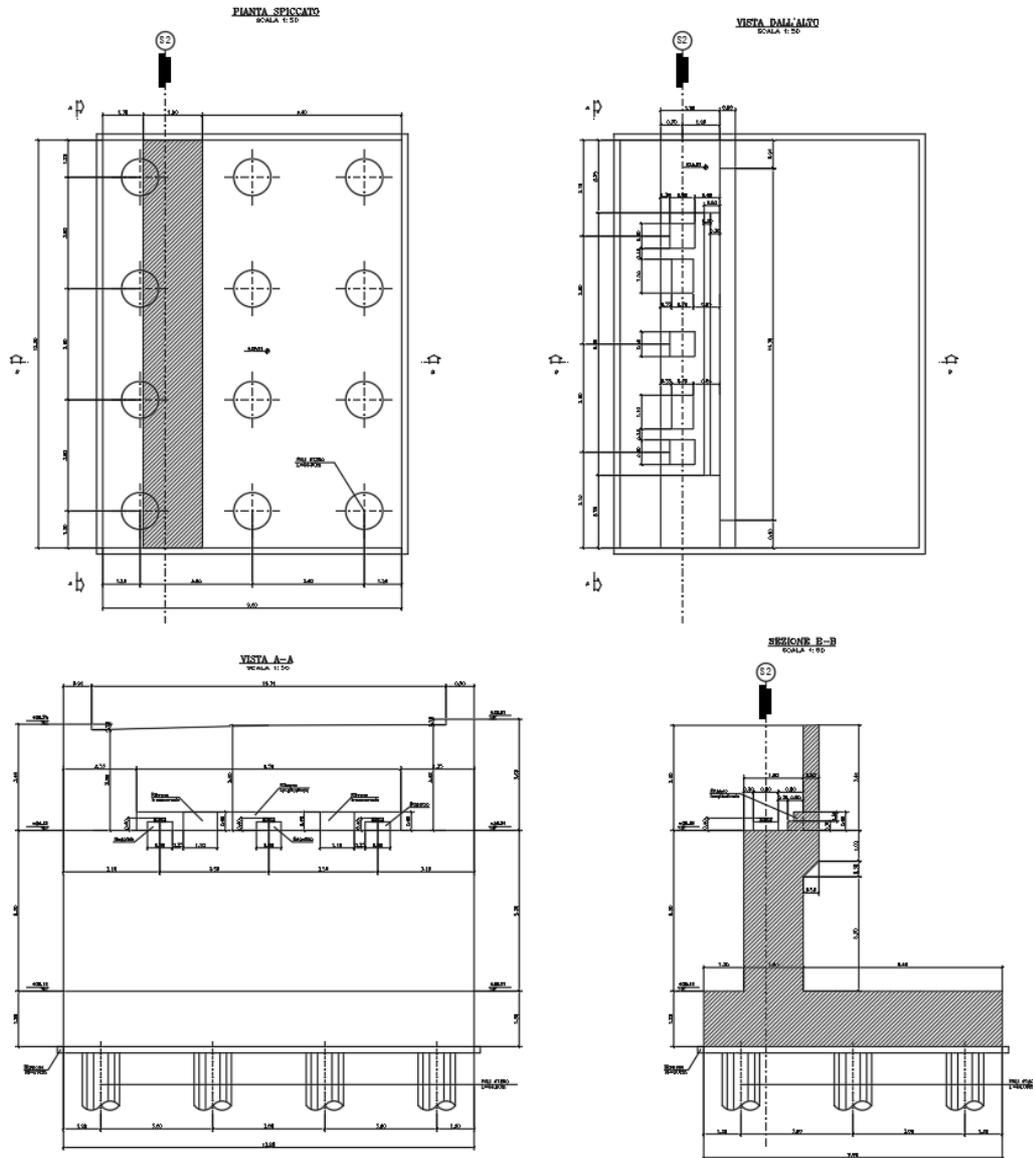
Sezione trasversale e pianta - Spalle
